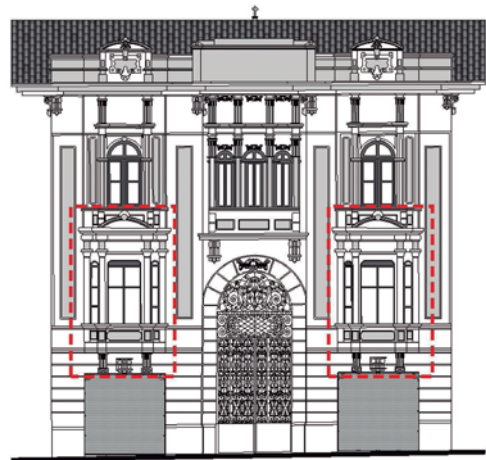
Emulación de pilastras entre primera y segunda planta alta.
